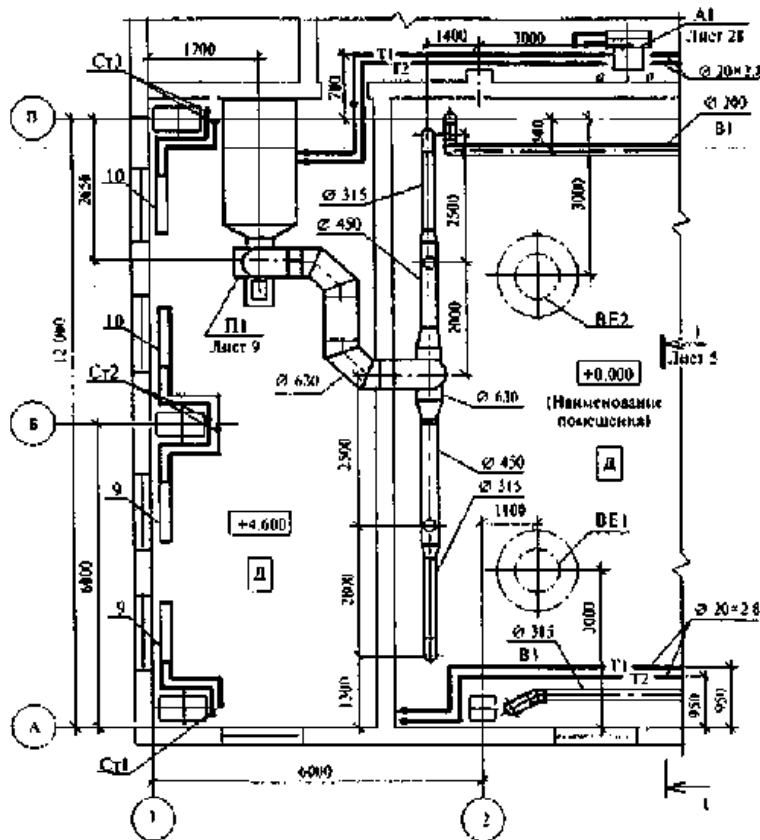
Пример выполнения плана систем отопления и вентиляции
